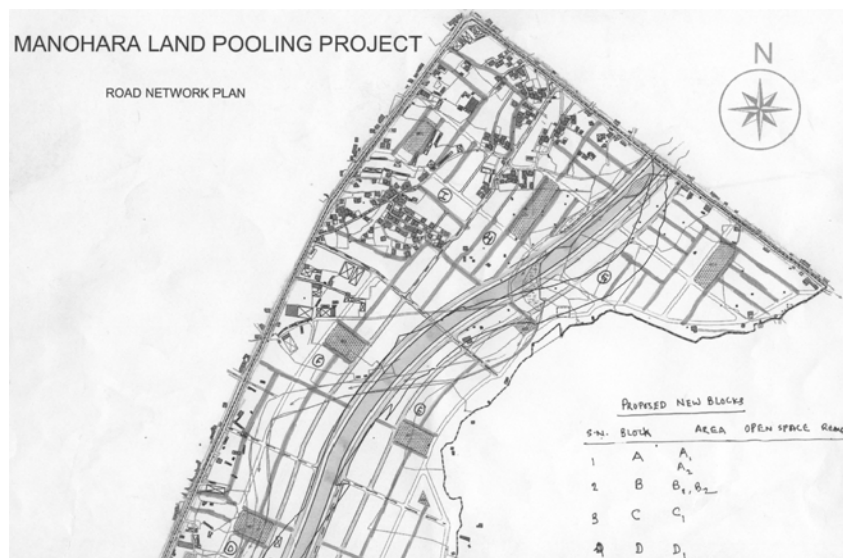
マノハラ土地プーリング事業の平面図(部分)
